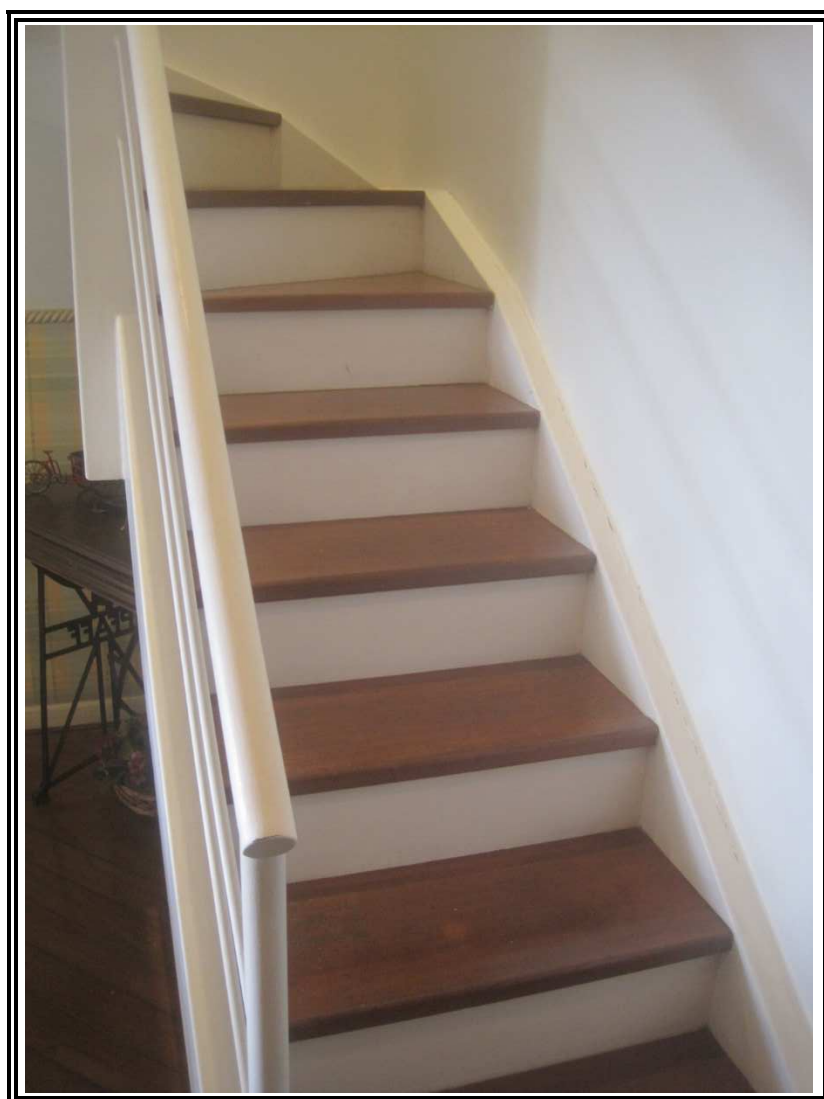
Vista da escada de acesso ao pavimento superior (cobertura)
